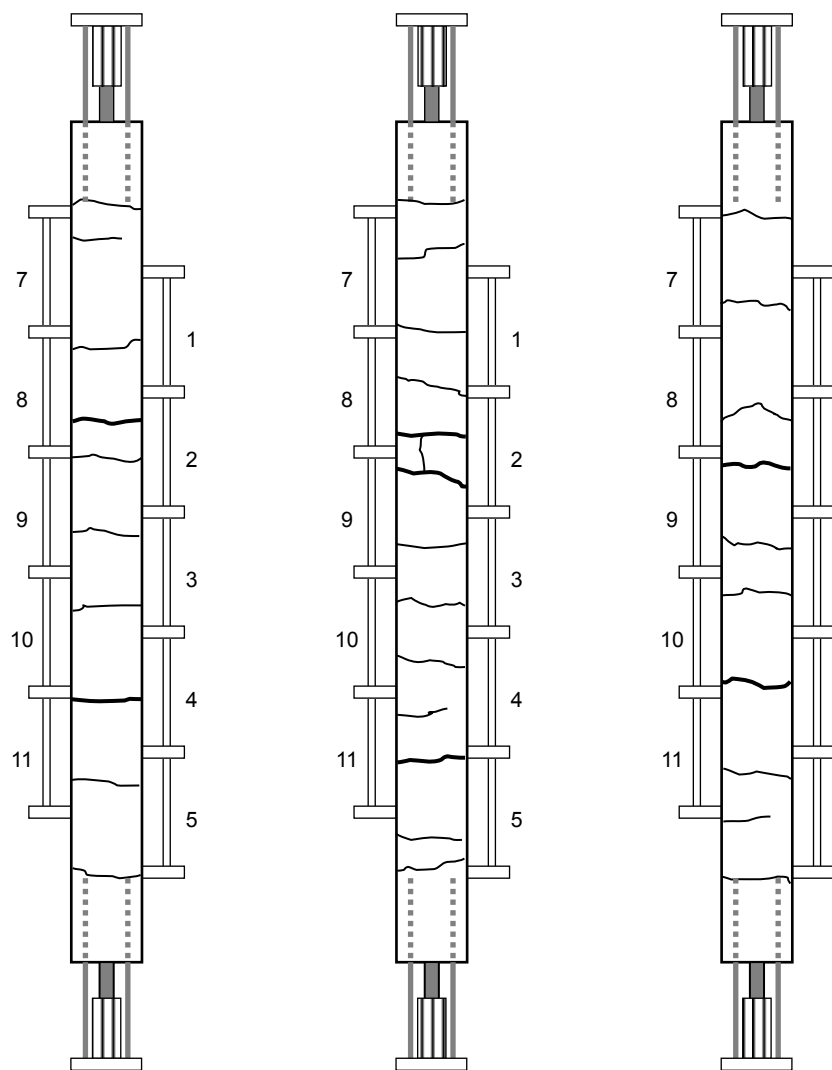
両引き試験体のひび割れ図(TS00)
